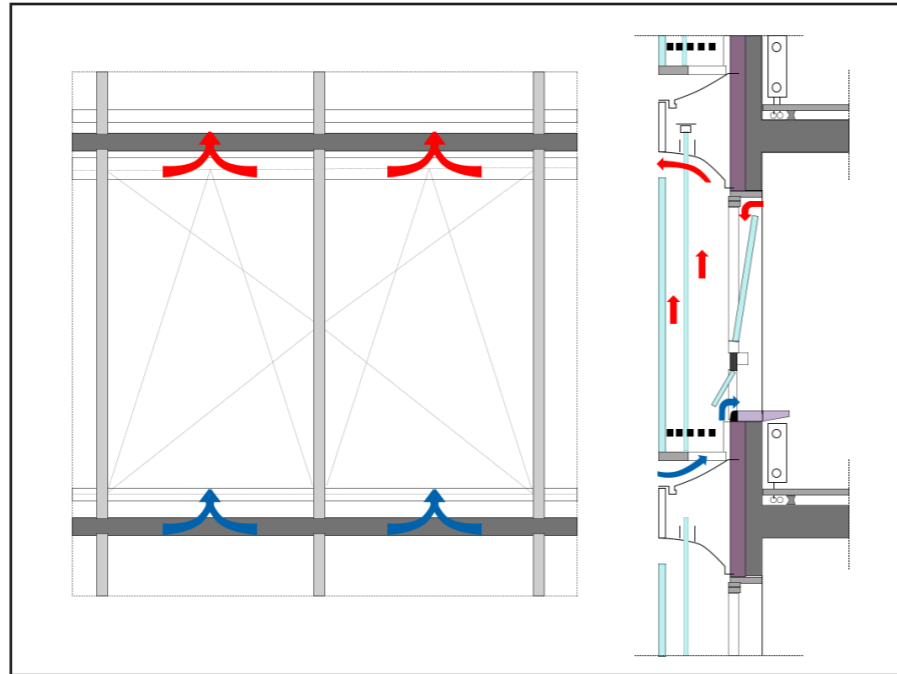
| Esquema de una Box-window, izquierda: alzado, derecha: sección.
